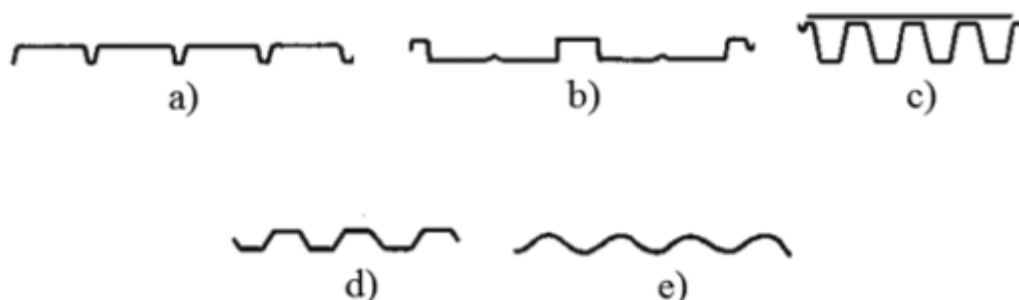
Exemplos de painéis em aço enformado a frio (Yu e LaBoube, 2010).
